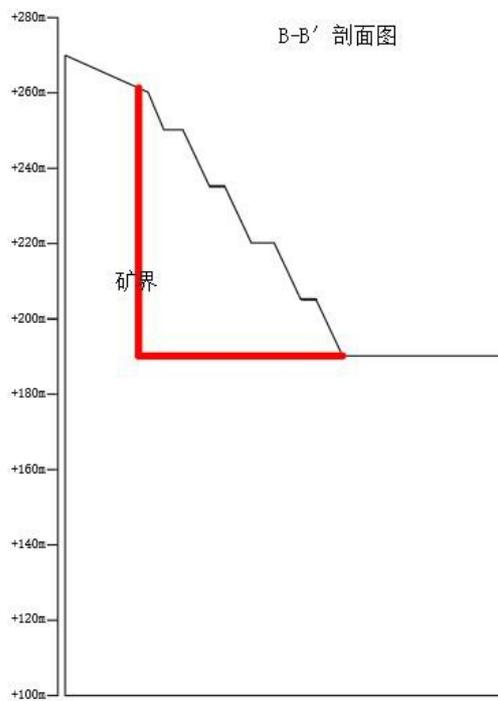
矿区西北侧边坡 B-B' 终了剖面图
